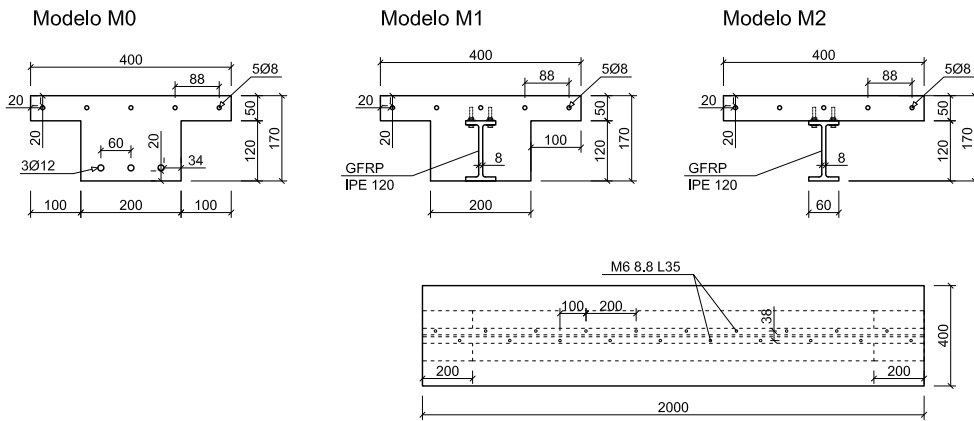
Detalles constructivos de los especímenes ensayados a escala real. Cotas en mm.
